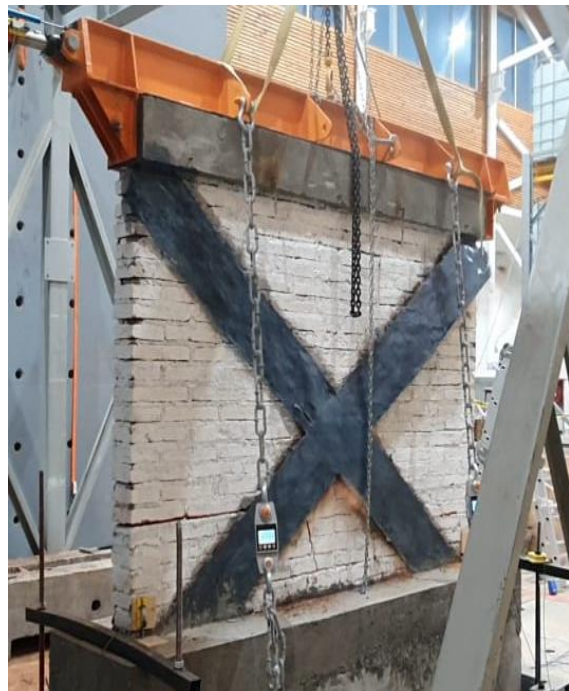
Falla del refuerzo de CFRP en el instante en que se desprende del muro de albañilería (Fuente: Elaboración propia)
